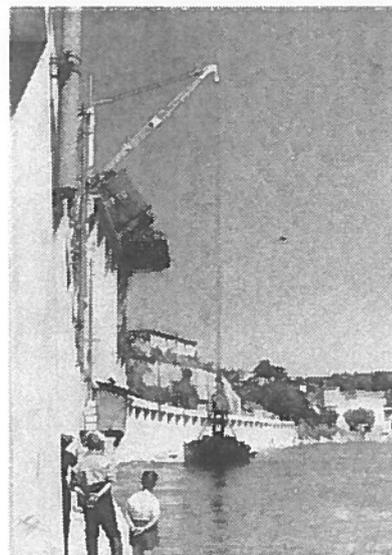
Montagem de um caixão do 3.º troço — Amarração
